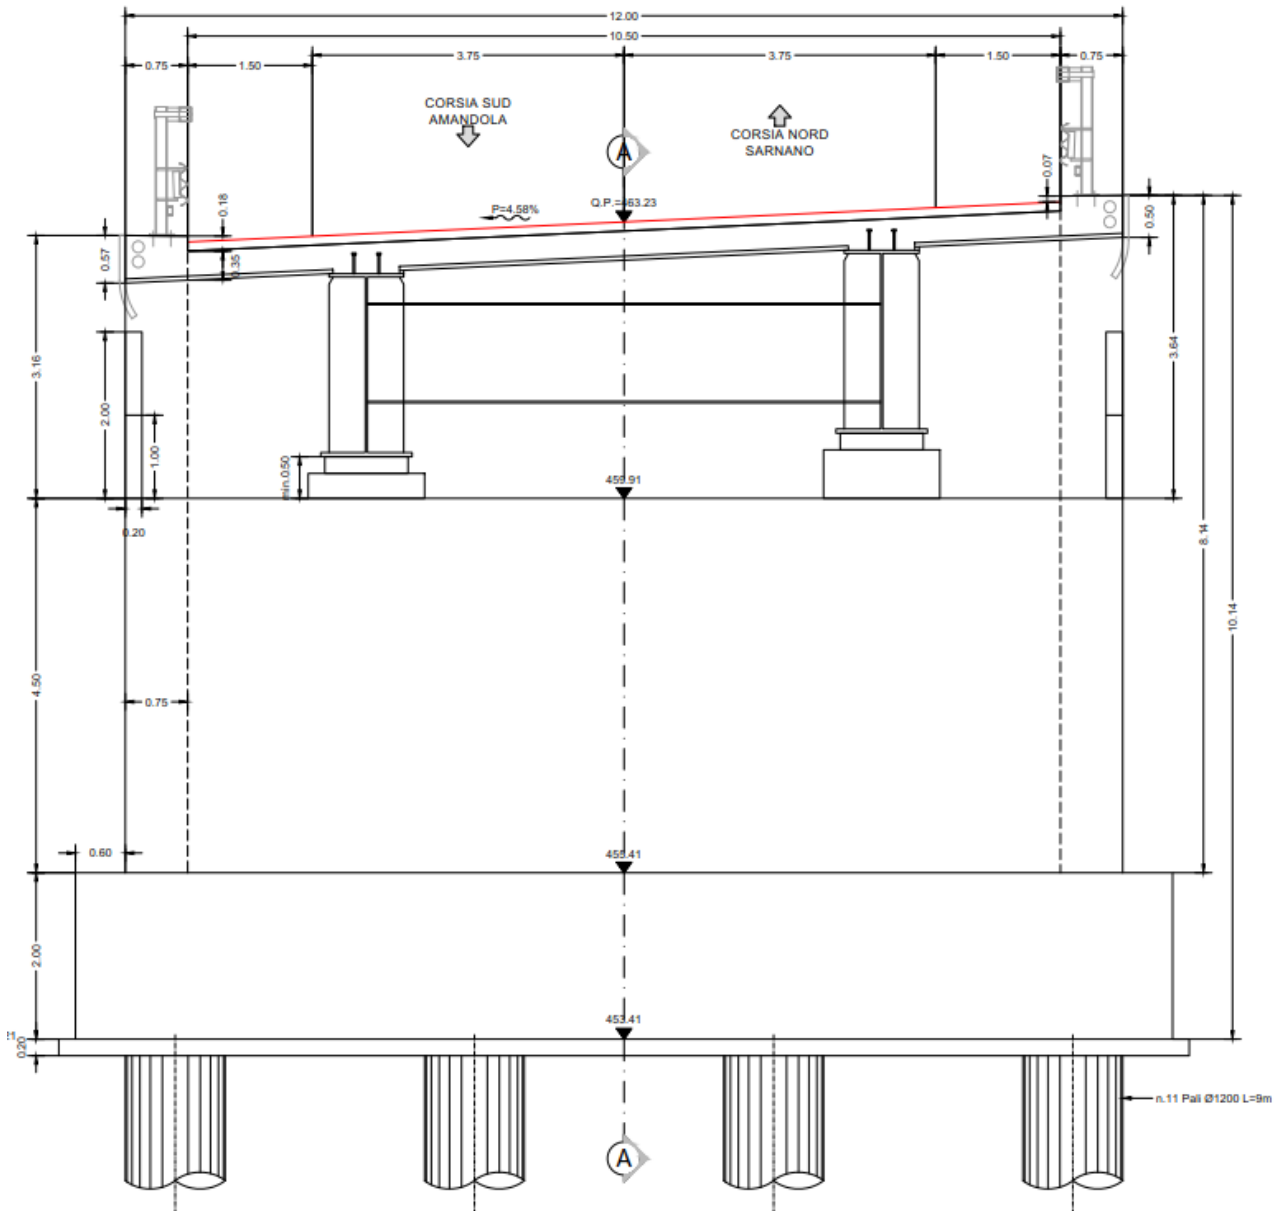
Vista frontale spalla A lato Sarnano
